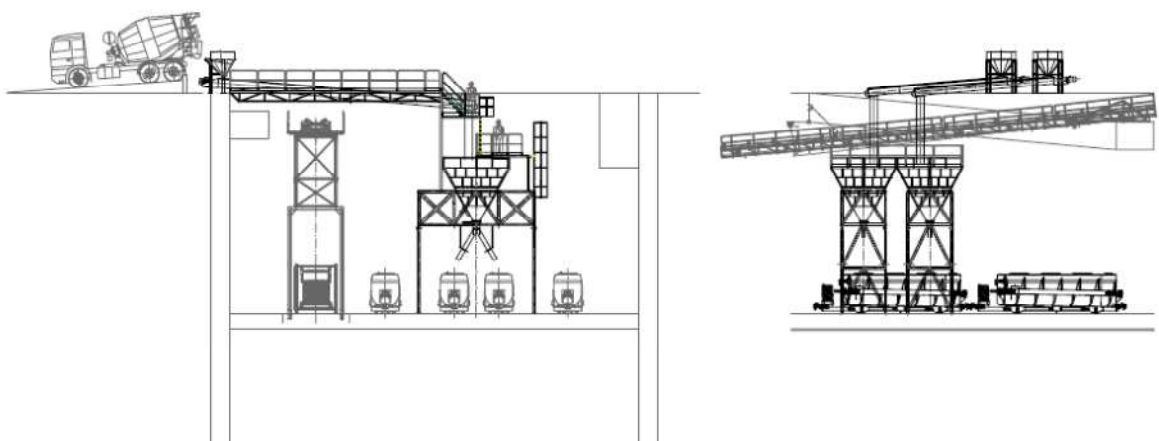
Croquis en perfil y alzado de la planta de descarga de Mortero Húmedo en la playa de vías.
